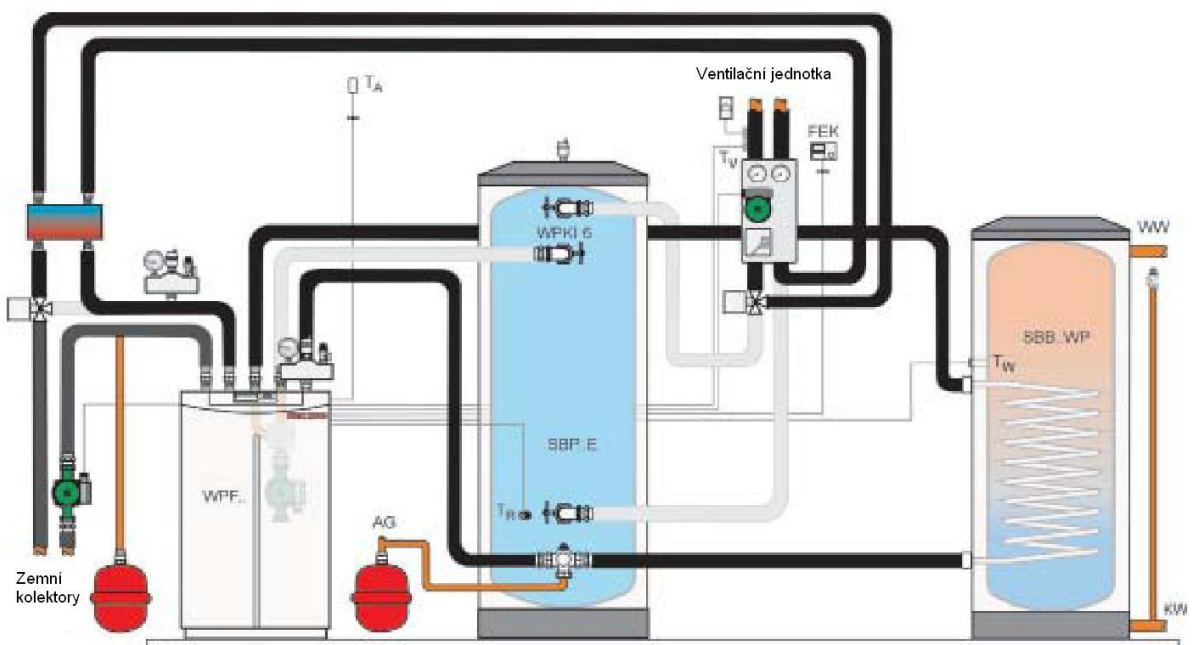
Hydraulické zapojení systému tepelného čerpadla
